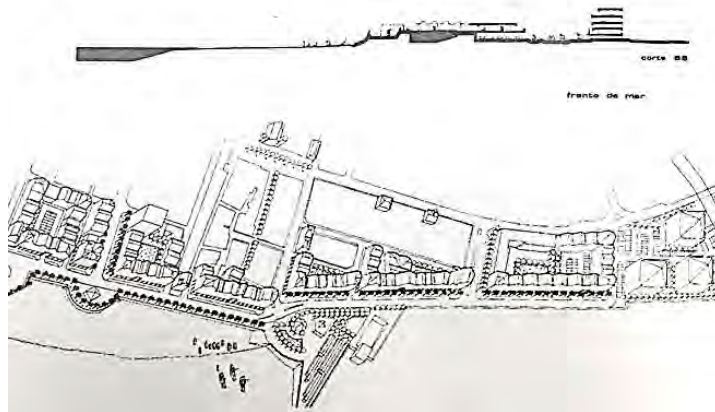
Plano da Área da Trafaria-Costa da Caparica. Planta geral - Proposta Final - utilização do solo, 1980
